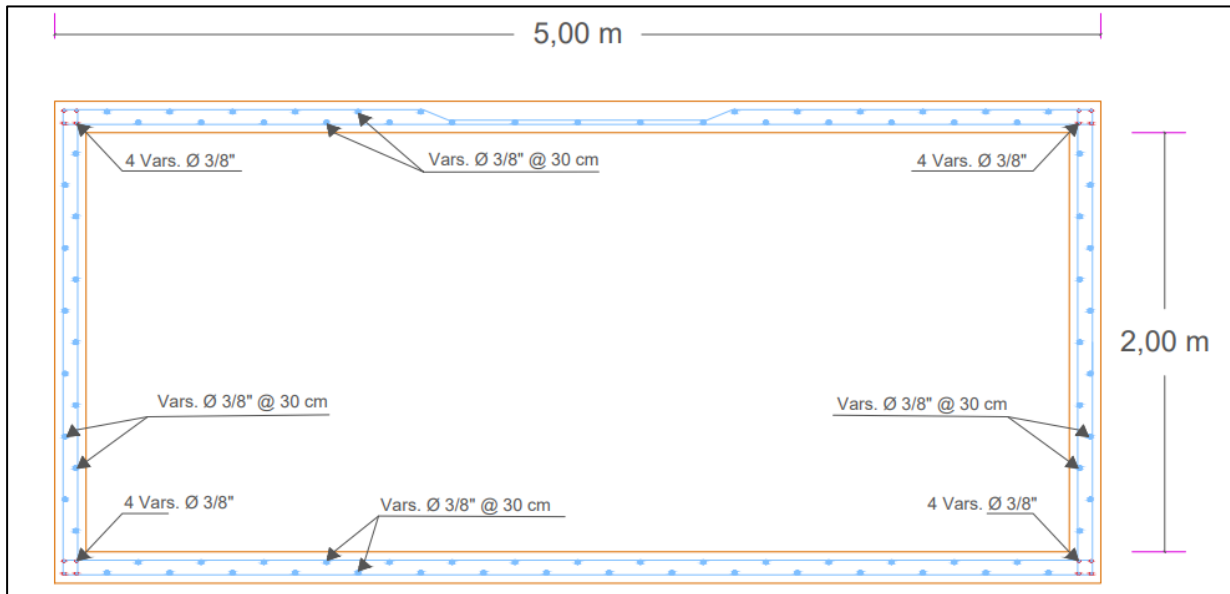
Detalle del trabe de la losa [Barahona & Rivas, 2022]
